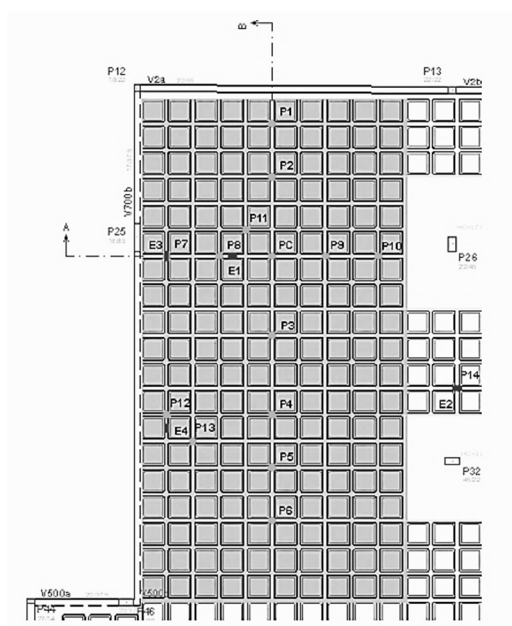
Planta de localização dos pontos de instrumentação e área de carregamento da laje CE2 [Fonte: SCHWETZ (2011)]
